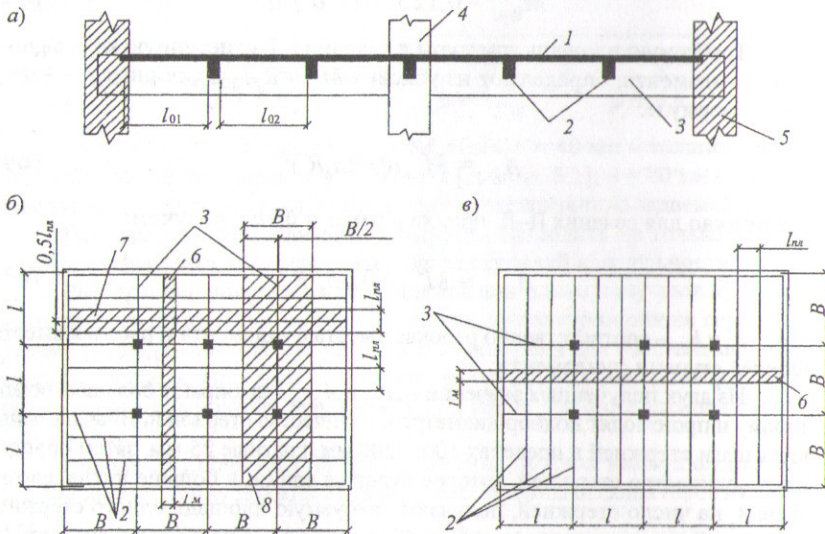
Конструктивная схема монолитного ребристого перекрытия с балочными плитами:
